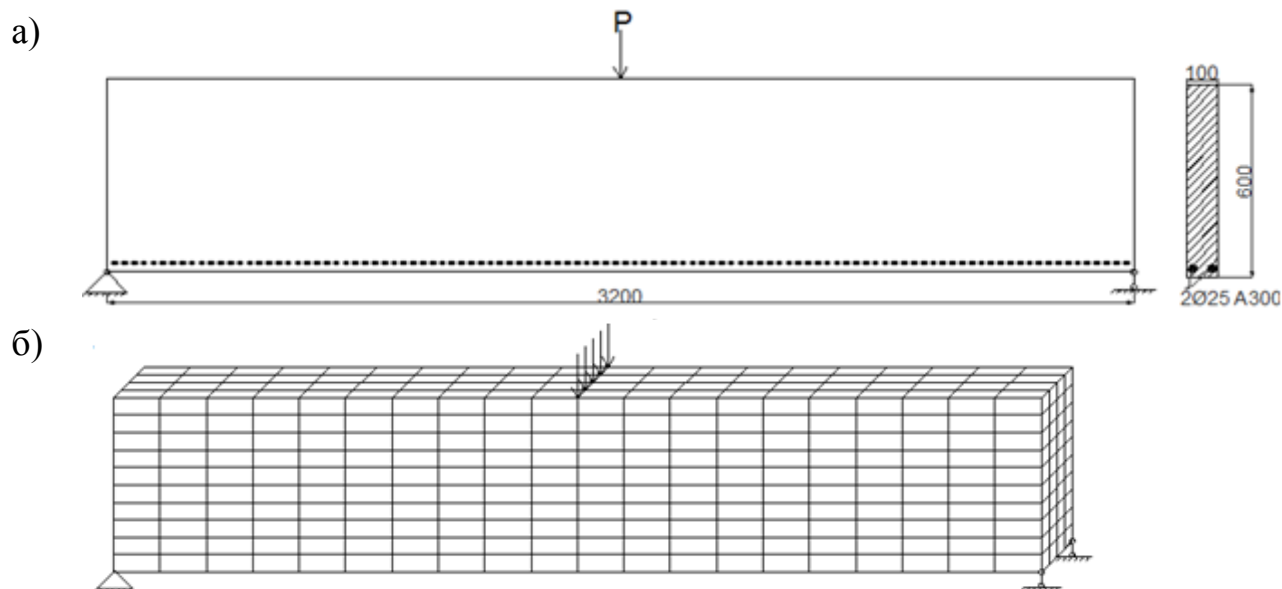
Модель балки: а - расчетная схема и конструкция железобетонной балки, б – схема разбивки на конечные элементы.
